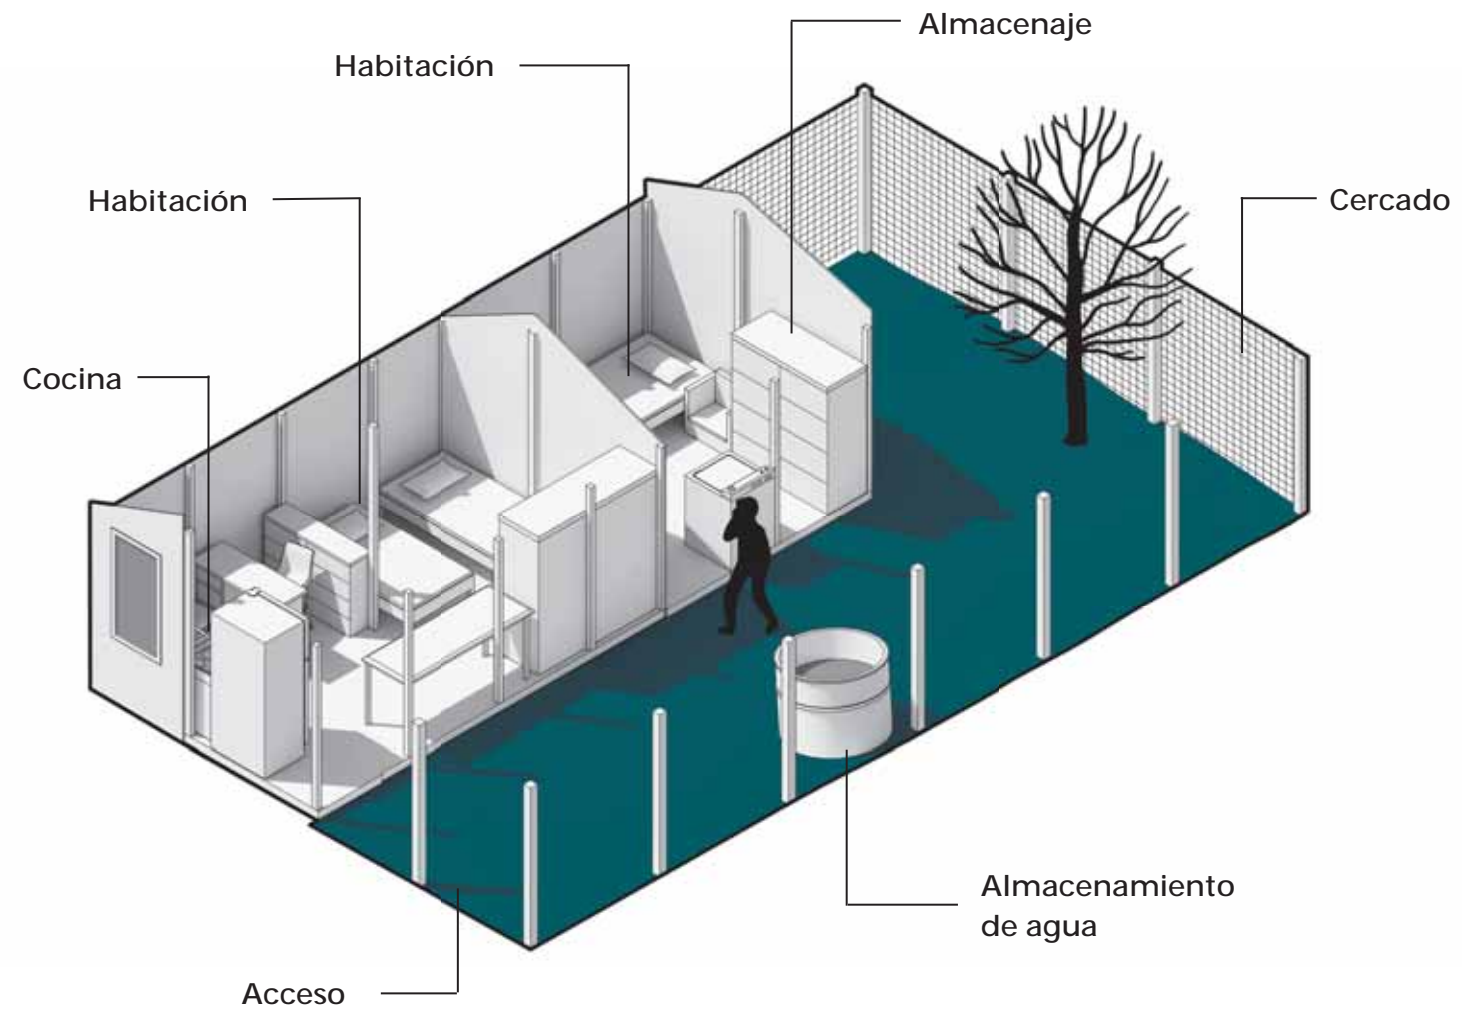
Corte Isométrico de la vivienda de Mello.
